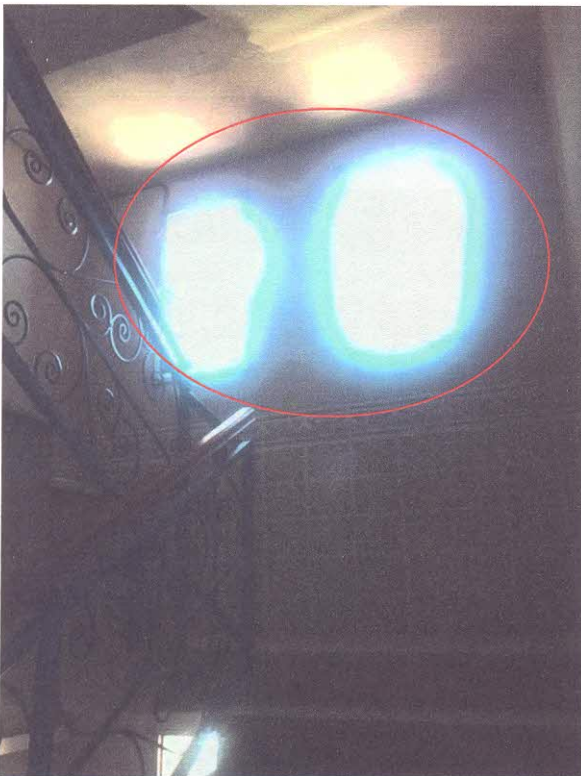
photo qui montre la grandeur des ouvertures au niveau de la cage d'escaliers
